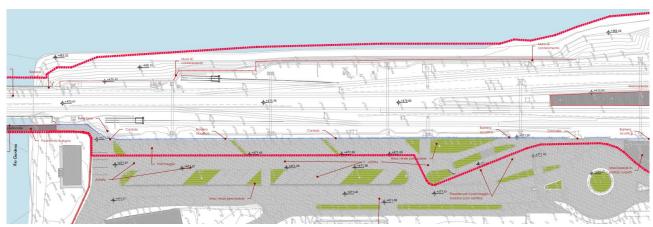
Planimetria generale ante operam - Rilievo planoaltimetrico
